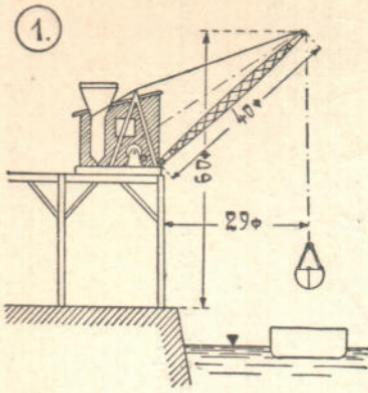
59. Схема некоторых механических устройств для перегрузки строительных материалов.
